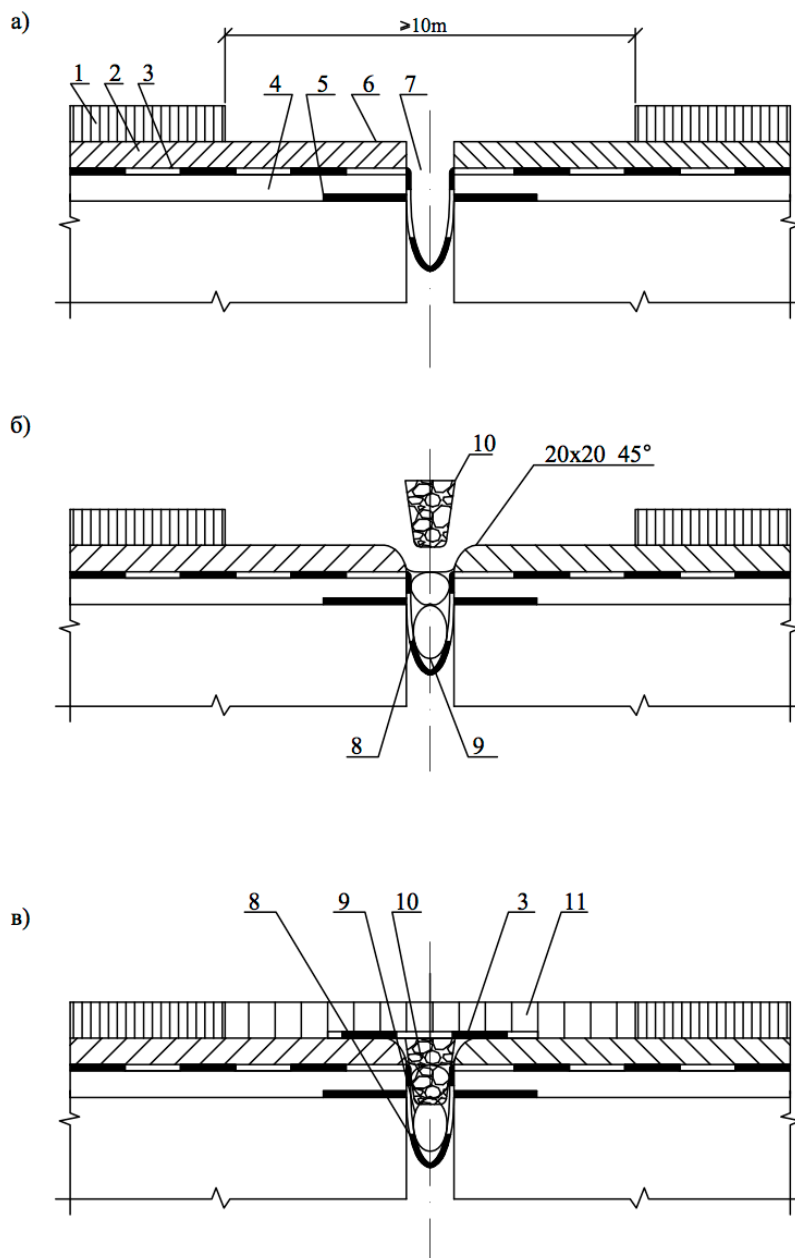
Схема ремонта скола кромки бетонного покрытия у шва:
